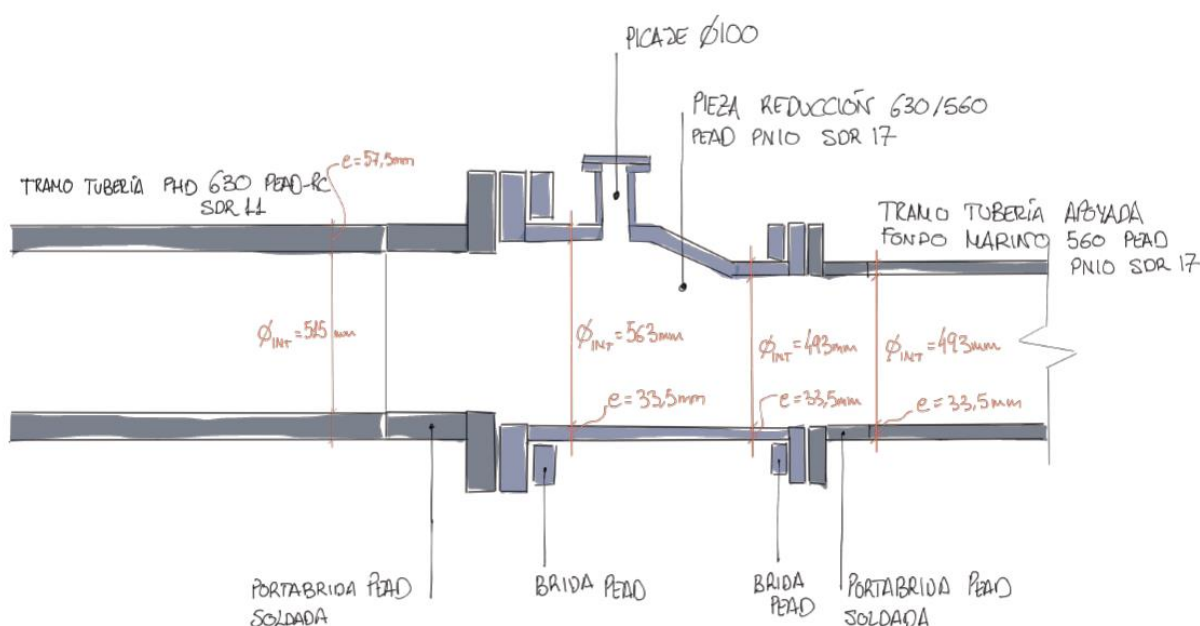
Croquis de la pieza de unión entre el tramo de tubería en PHD y tramo de tubería apoyado en fondo marino. Fuente: Propia
